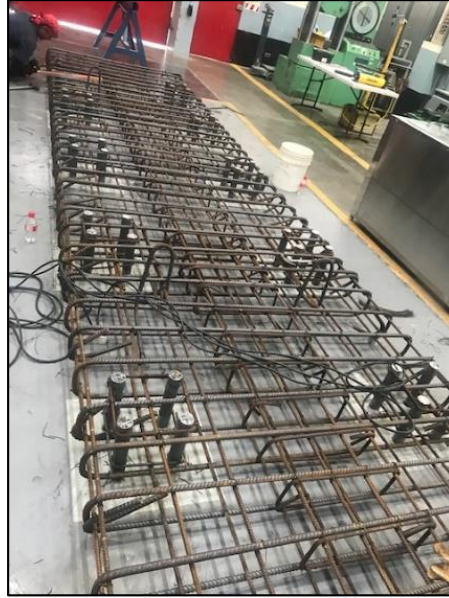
Colocación de pasantes de PVC en armadura de cimentación.
